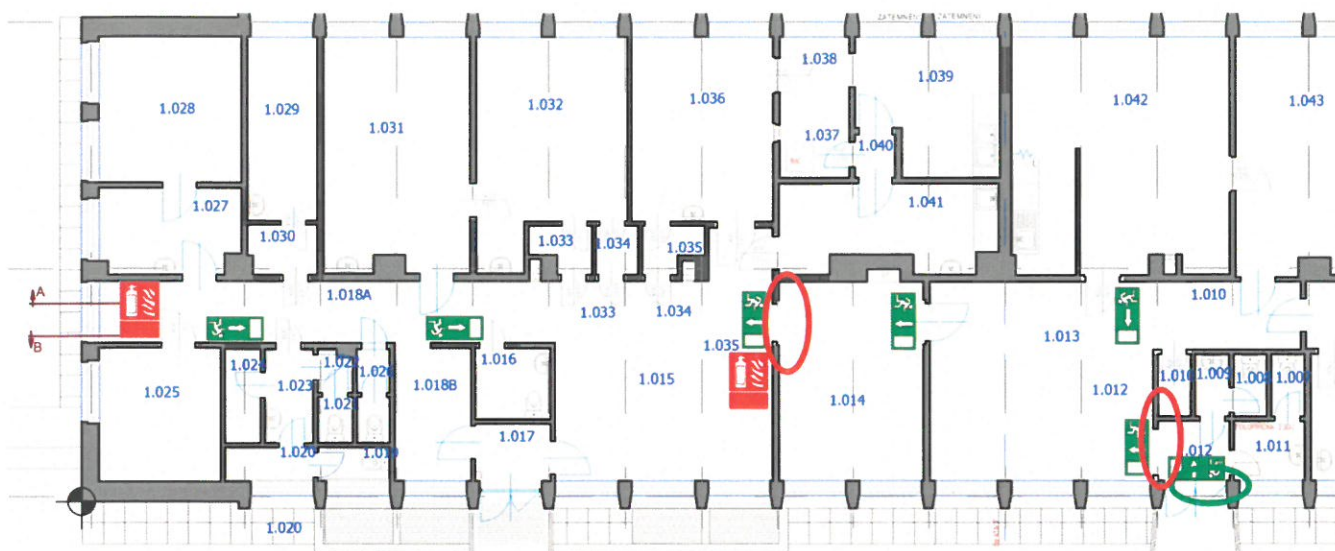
Část půdorysu 2.NP\_1. etapa stavby
